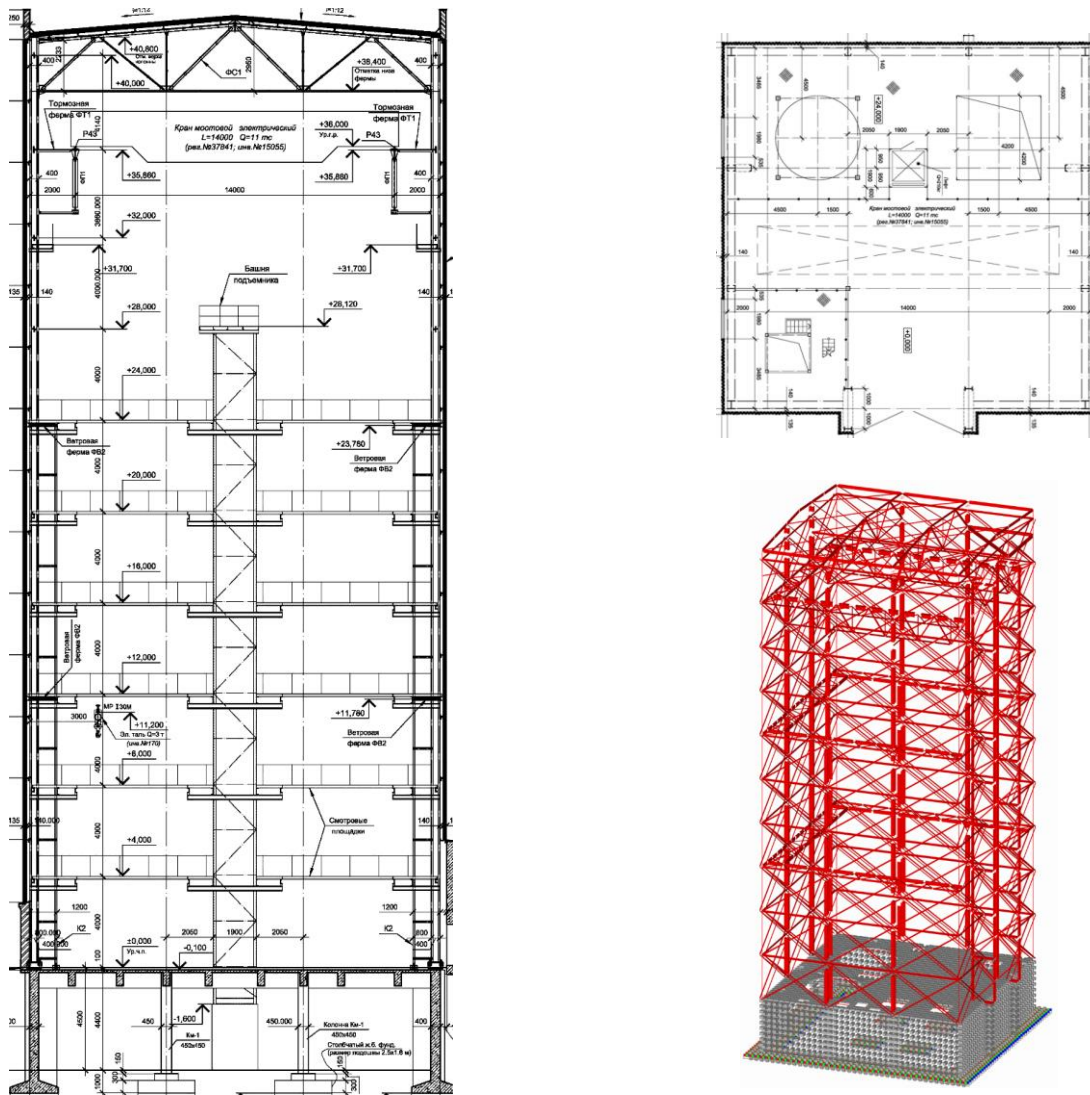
Об'єкт дослідження – просторовий сталевий каркас, розріз та план будівлі
